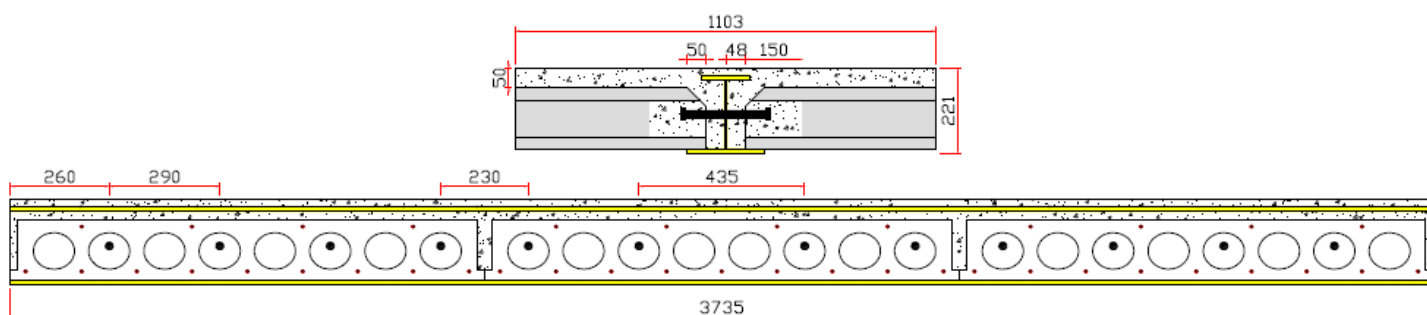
Posição da armadura transversal e colocação do EPS nos alvéolos.
